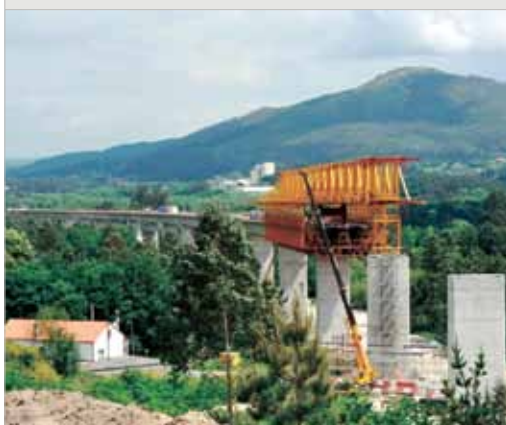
Cimbra autolanzable cerrada antes del inicio de la construcción de un vano durante la construcción del viaducto del Sar
